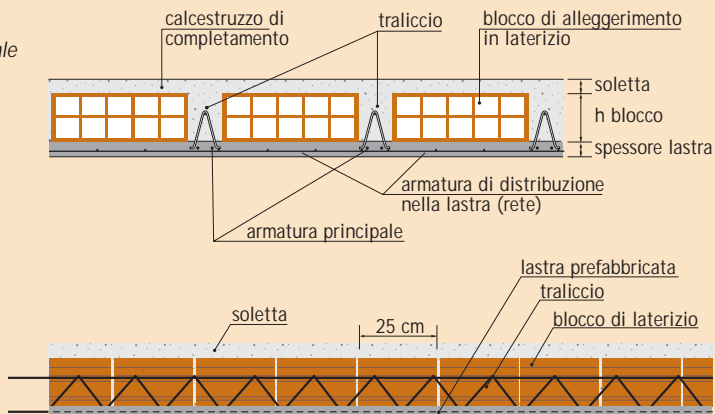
a - Solaio a lastre in c.a. normale e alleggerimento in laterizio.
